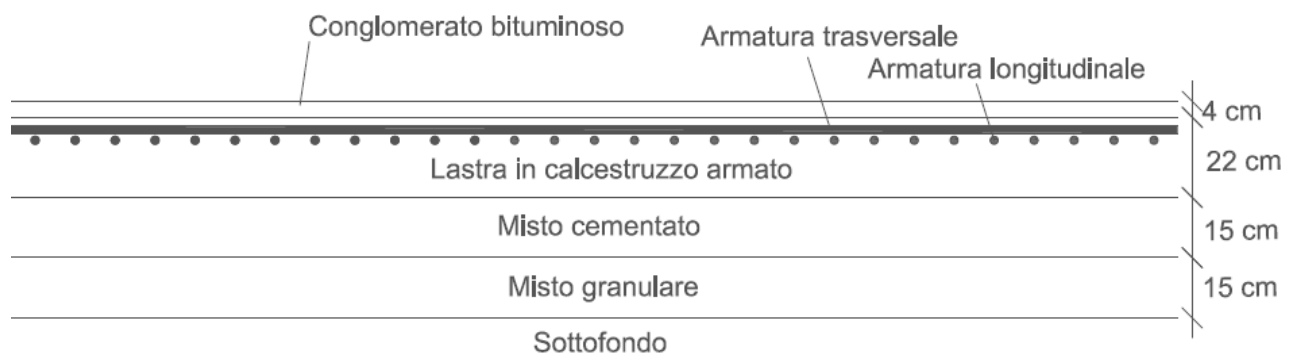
K – Pavimentazione rigida per l'area operativa
